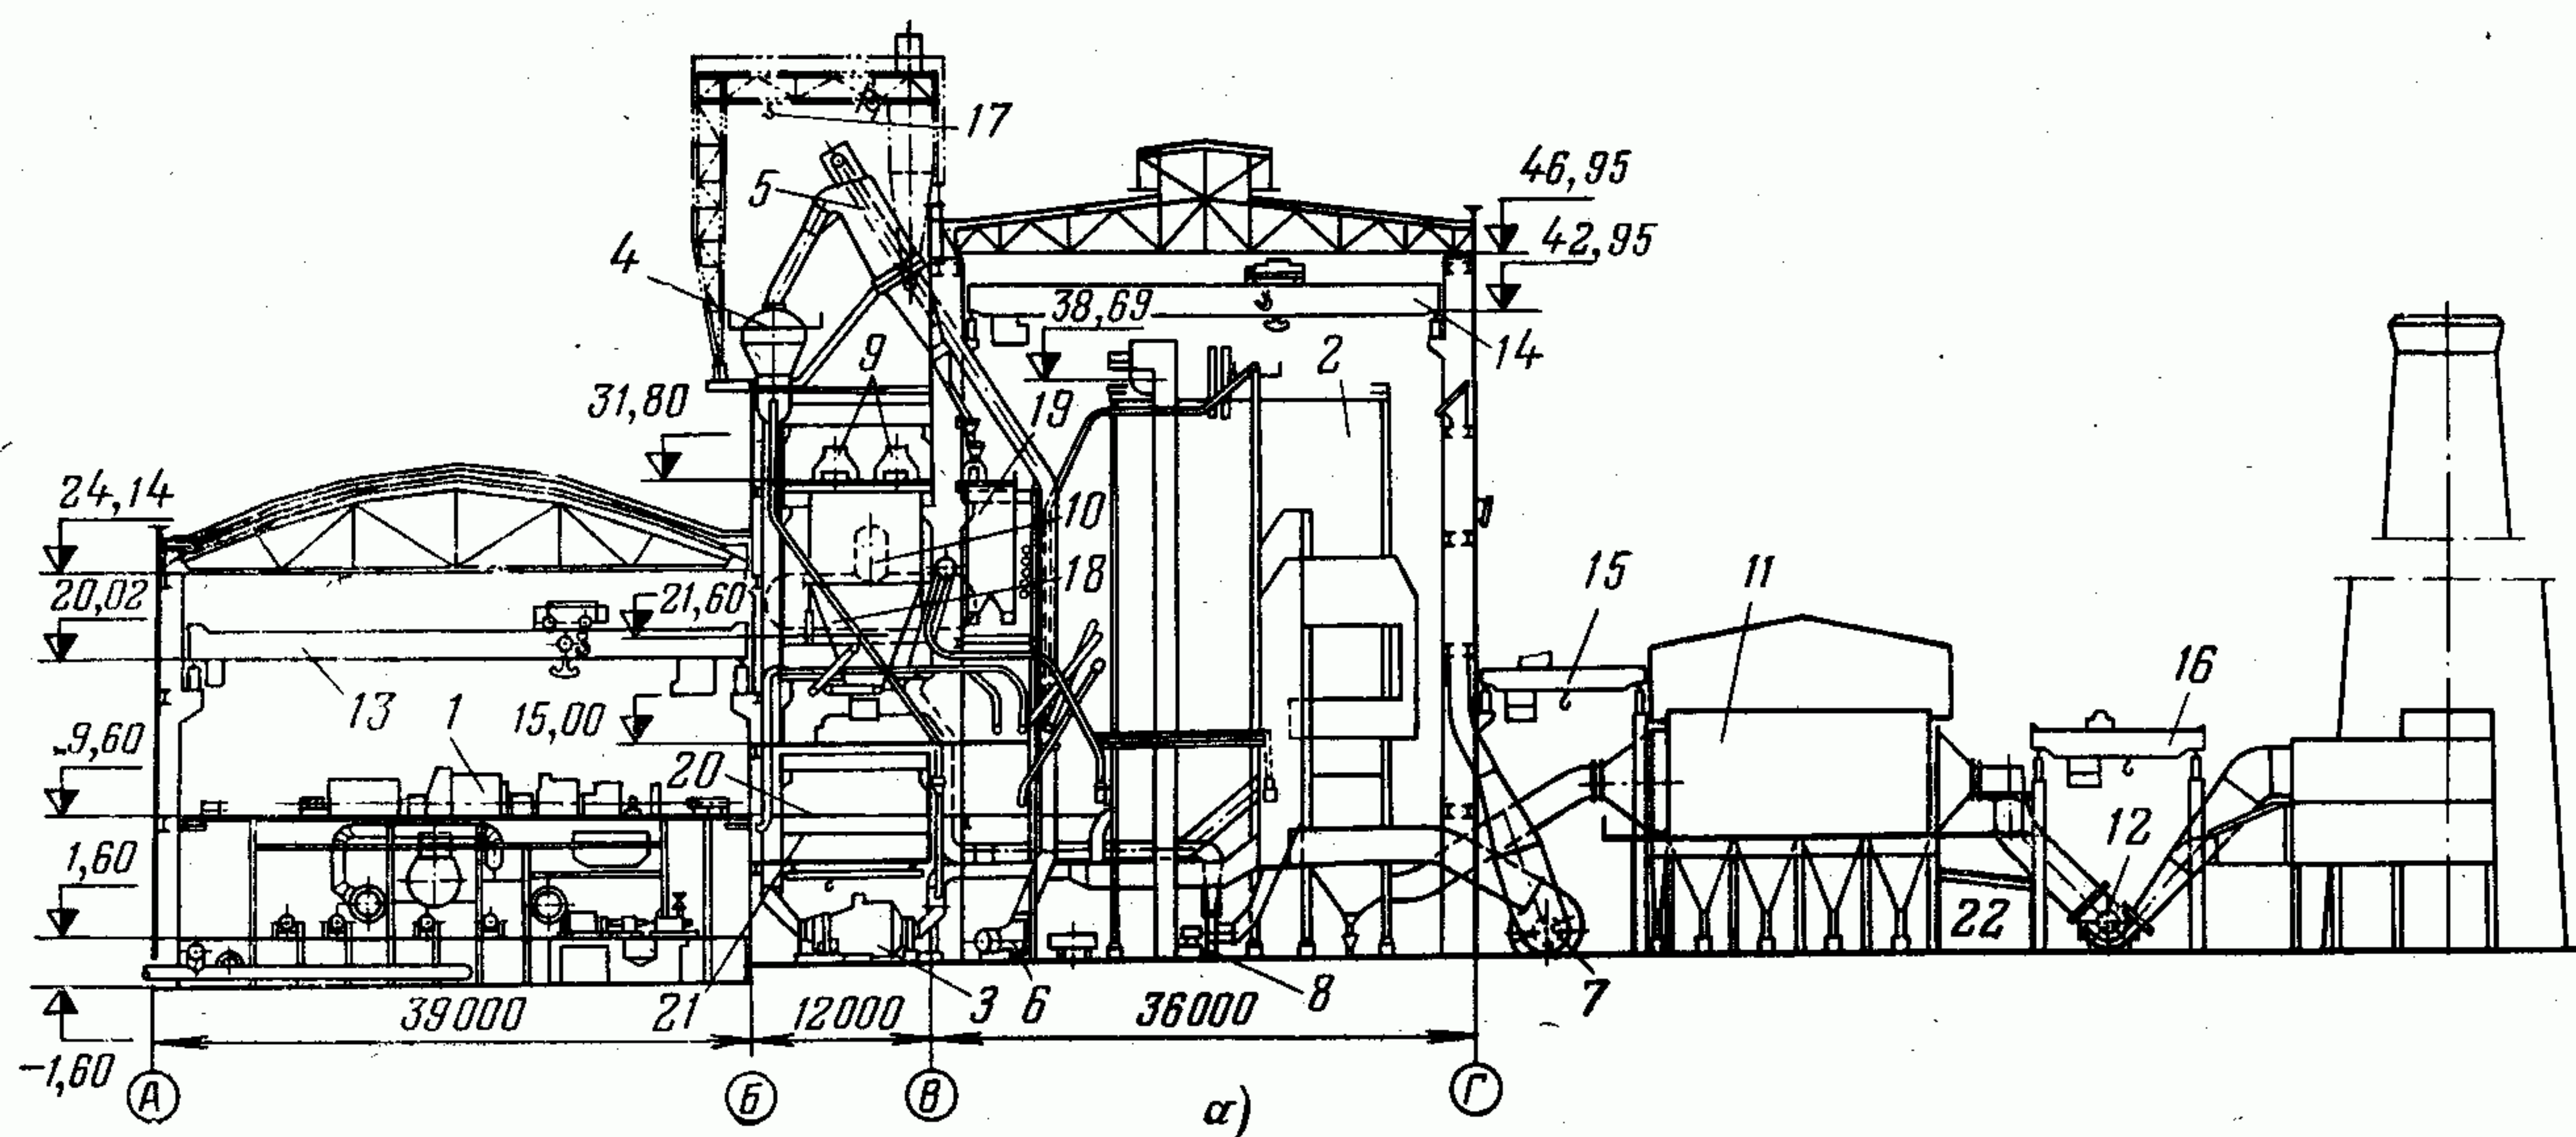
Компонка главного корпуса пылеугольной ТЭЦ с шаровыми барабанными мельницами.
